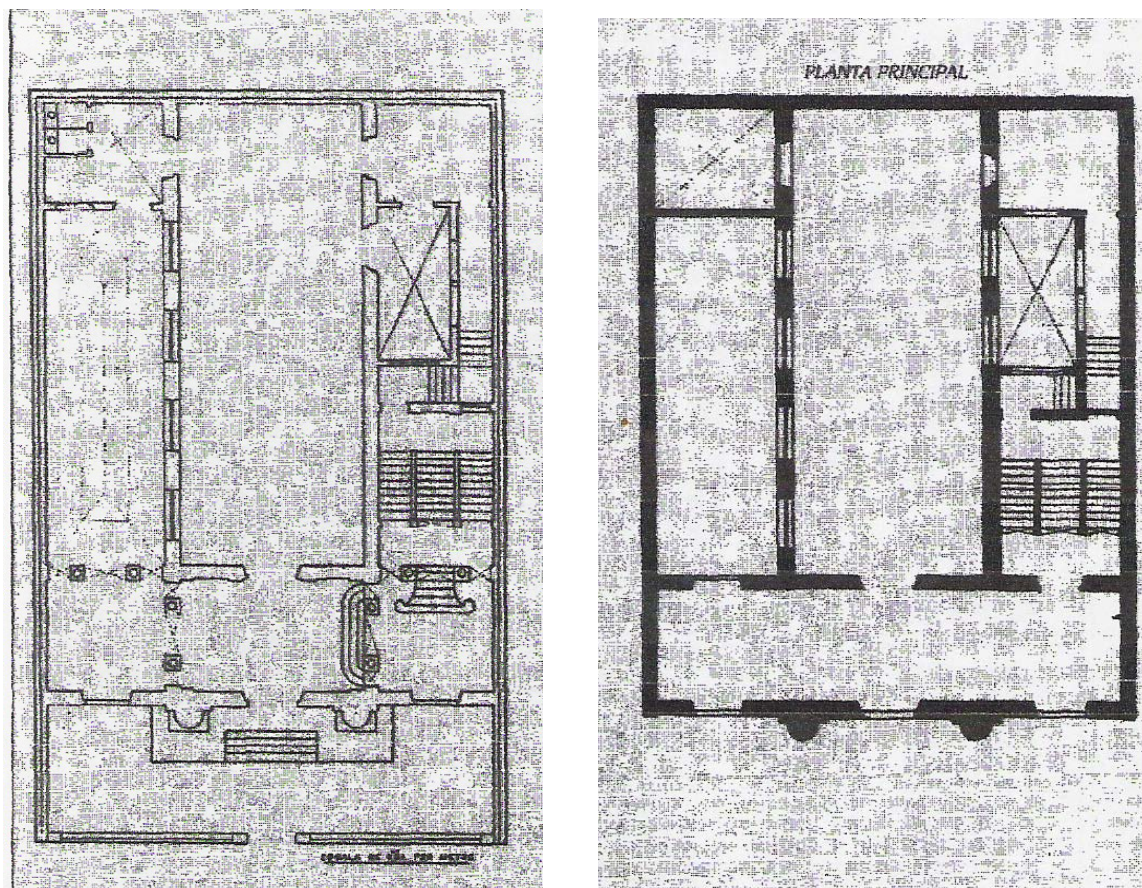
Planos de Planta Baja y Planta Principal correspondientes al proyecto original de 1900.
